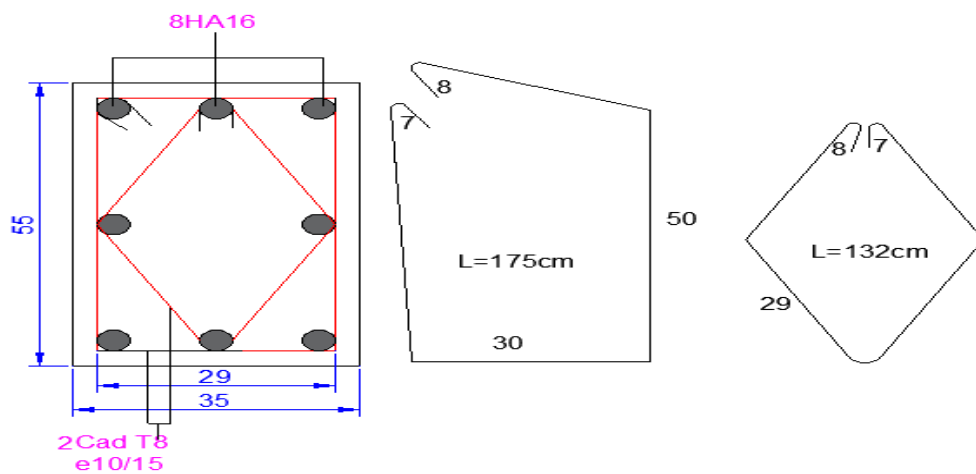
Schéma de ferrailage poteaux (35x55) :
